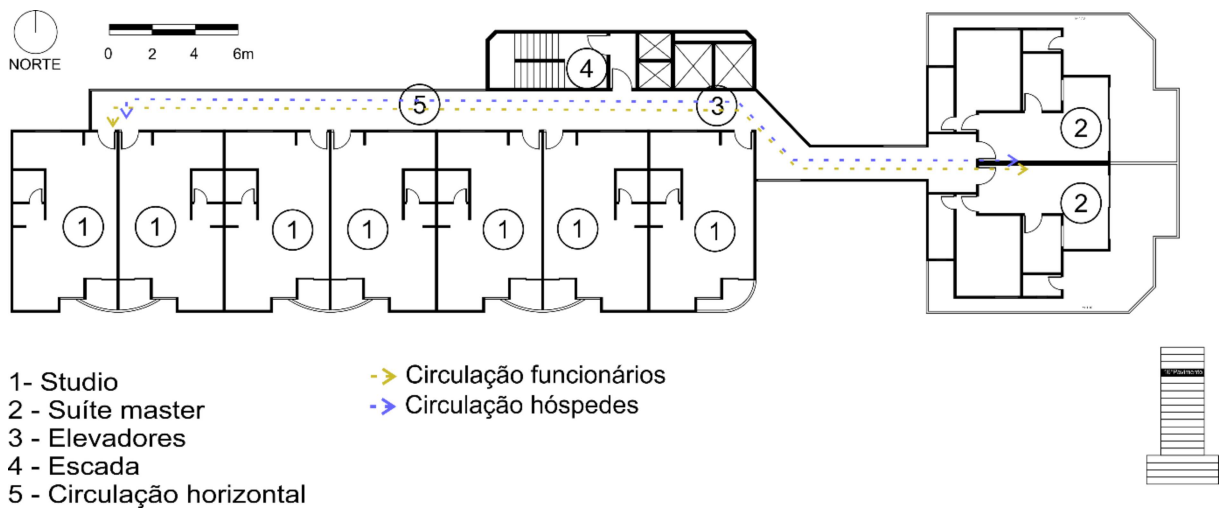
Planta baixa 13º ao 15º pavimento.
